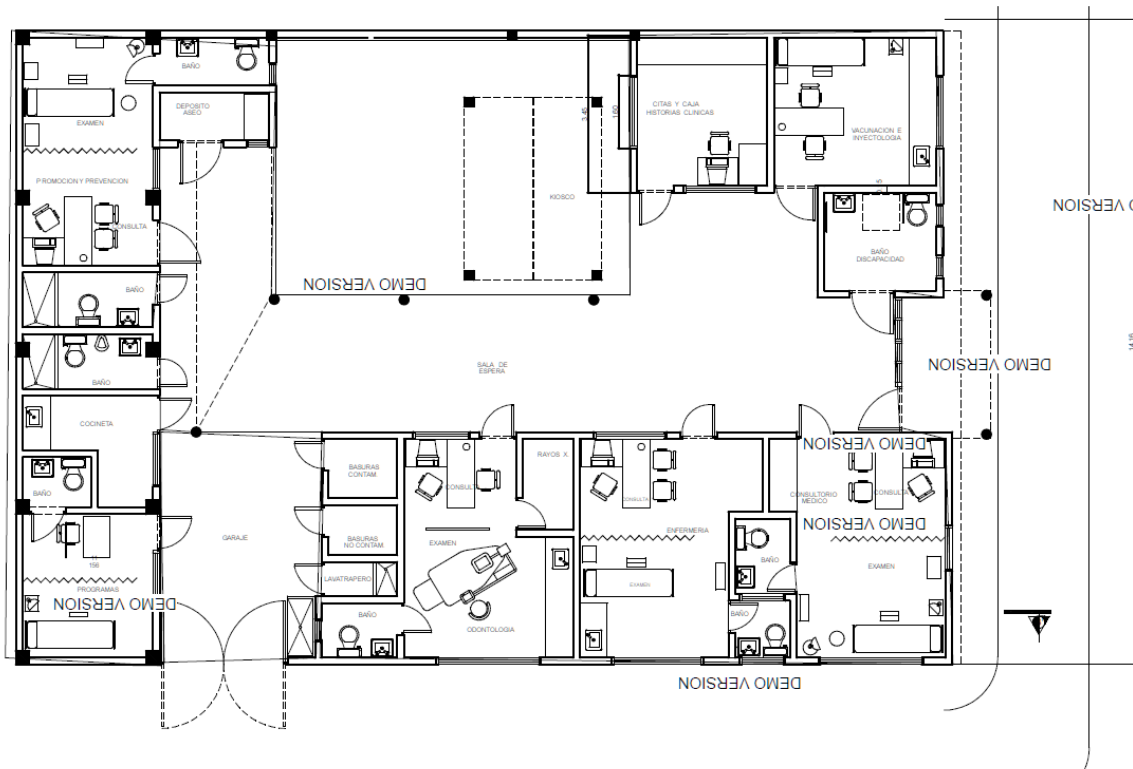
Planta arquitectónico IPS CUNDINAMARCA
